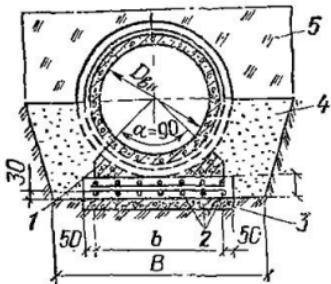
Укладка раструбных труб на железобетонное основание
